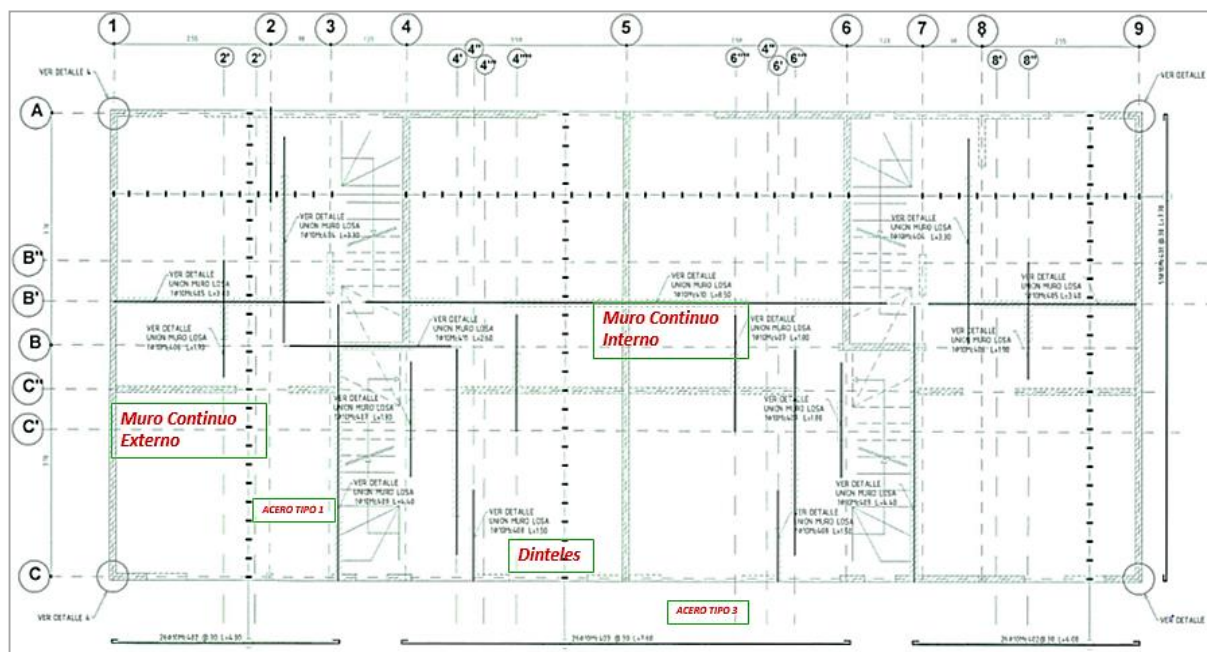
Refuerzo para losas de entrepiso y cubierta. Casa C82G
